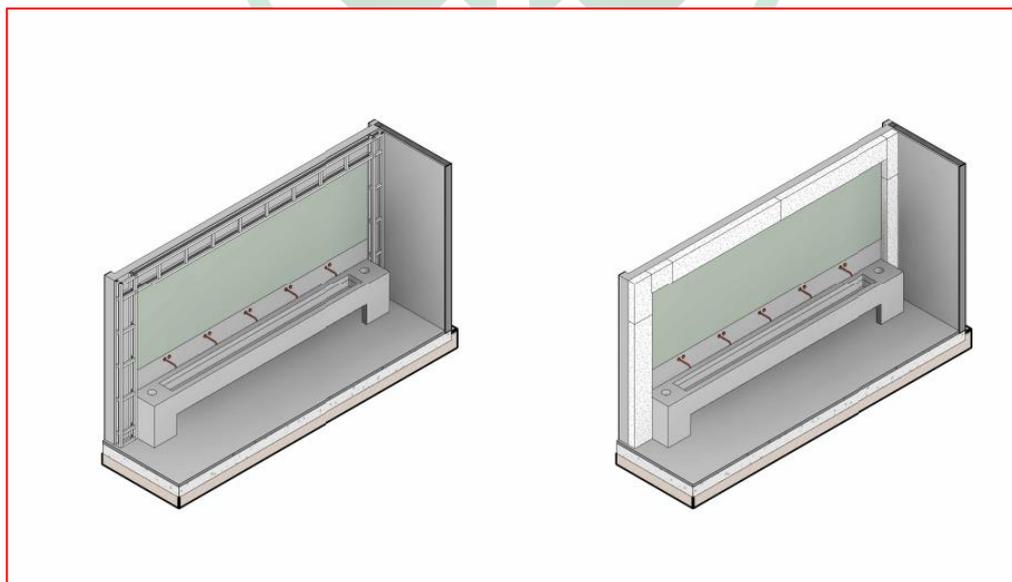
Detalhes em steel-frame do lavatório - Fonte: CEASA/PR e AUEN
